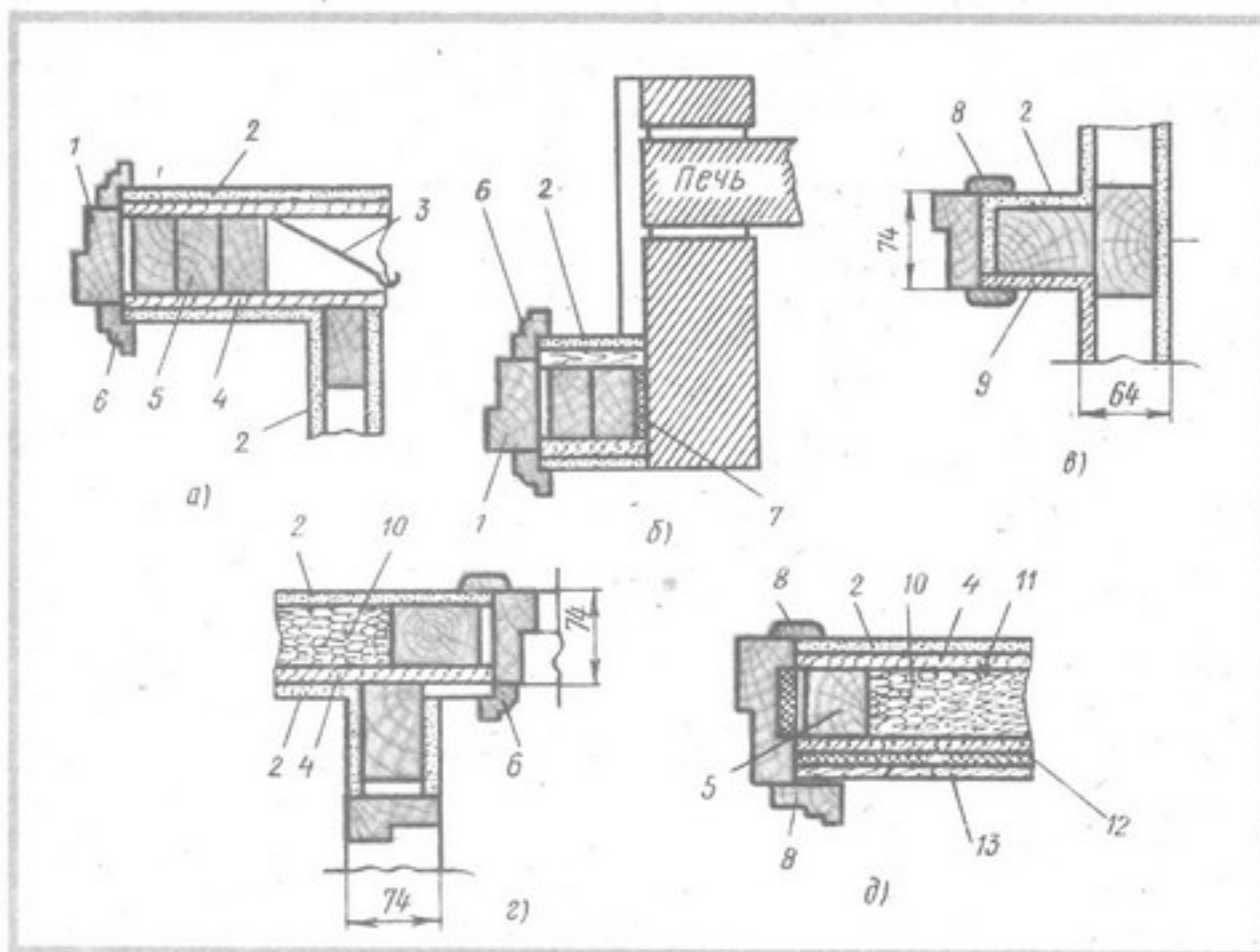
Установка дверных коробок в деревянных домах каркасной конструкции:
